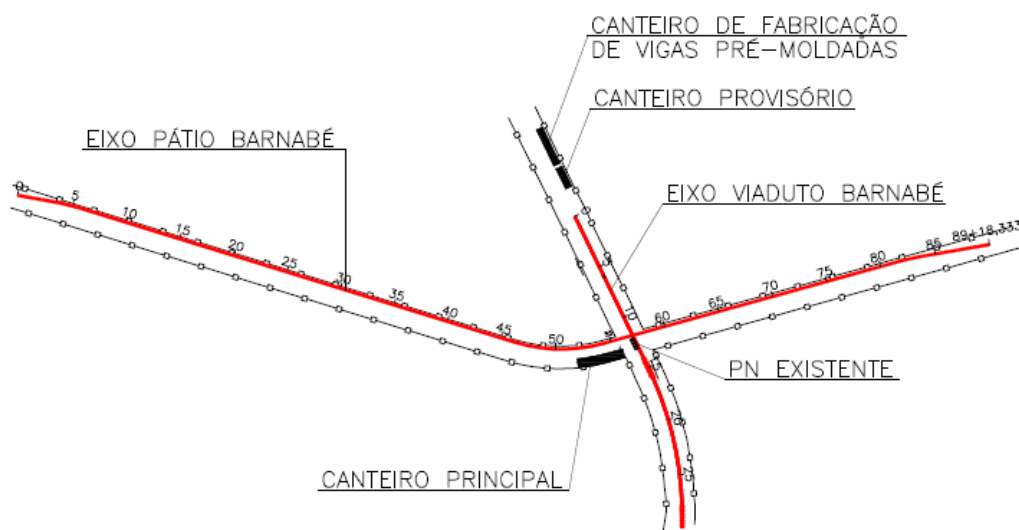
Localização do canteiro de obras principal e das áreas de apoio.
